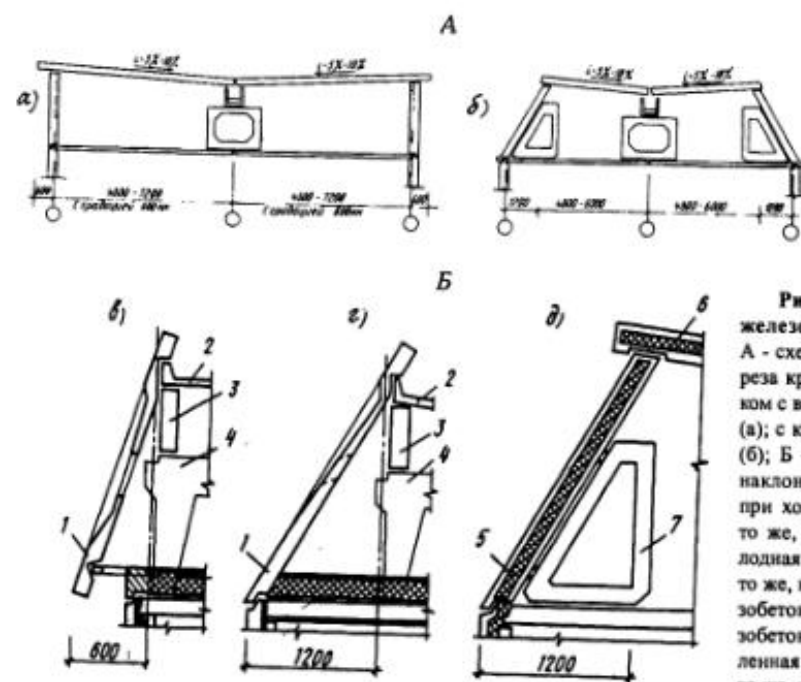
Чердачные железобетонные крыши: А - схемы поперечного разреза крыши с теплым чердаком с вертикальным фризом (а); с крутоскатным фризом (б); Б - детали устройства наклонного фриза; а, г - при холодном чердаке; д - то же, при теплом; 1 - холодная фризовая панель; 2 - то же, кровельная; 3 - железобетонная балка; 4 - железобетонная рама; 5 - утепленная фризовая панель; 6 - то же, кровельная; 7 - опорная конструкция фризовой панели
